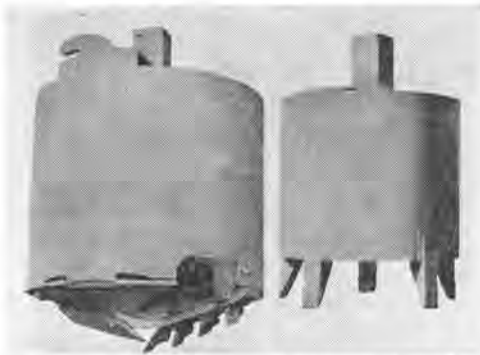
ドリルバケット, 写真-5 チョッピングバケット
